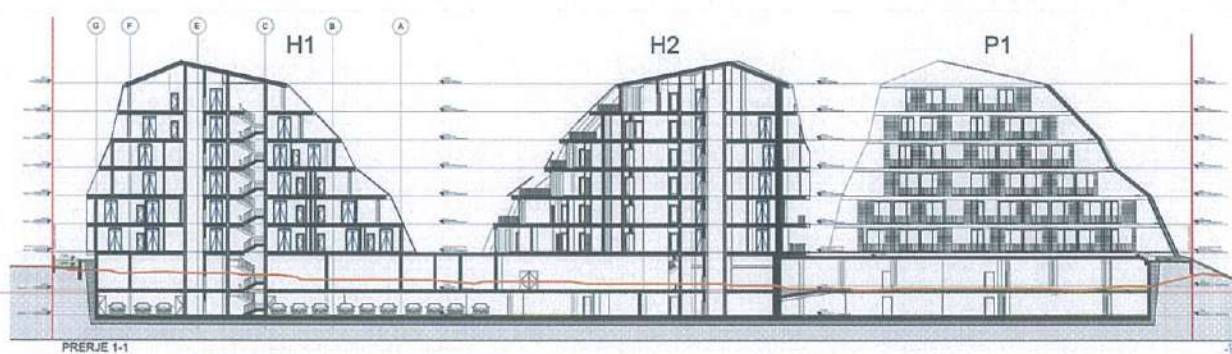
Hoteli, planvendosje, planimetri, pamje dhe prerje
